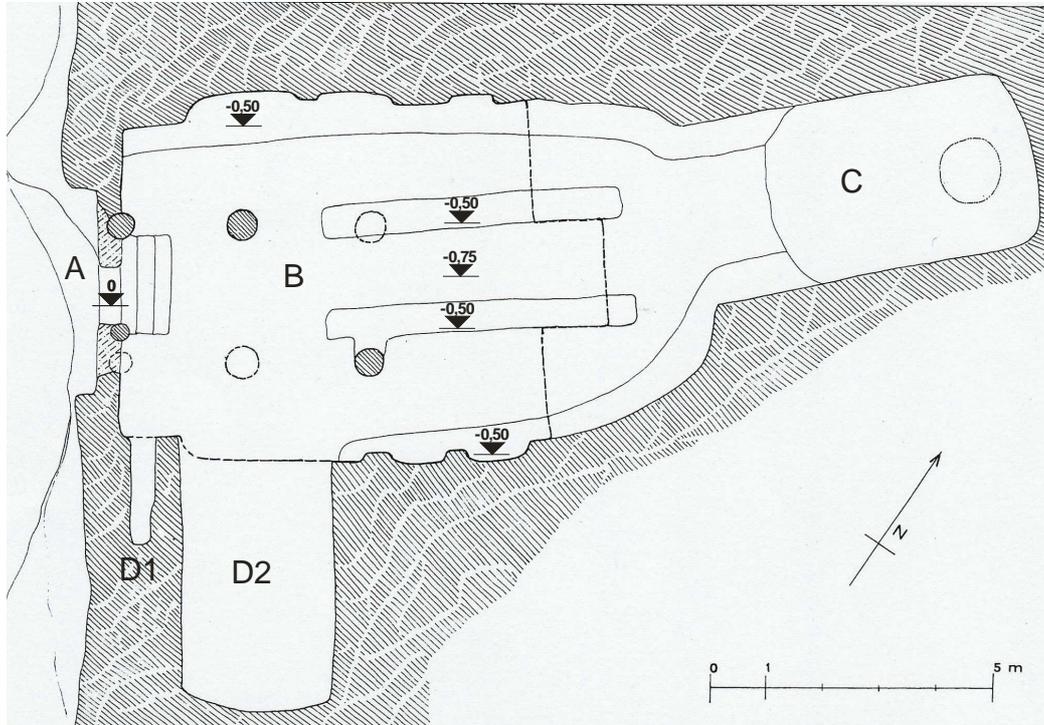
Chiesa rupestre di Marco Simone Vecchio. Planimetria (fonte: Quilici – Quilici Gigli 1992, modificato dall'autore).
